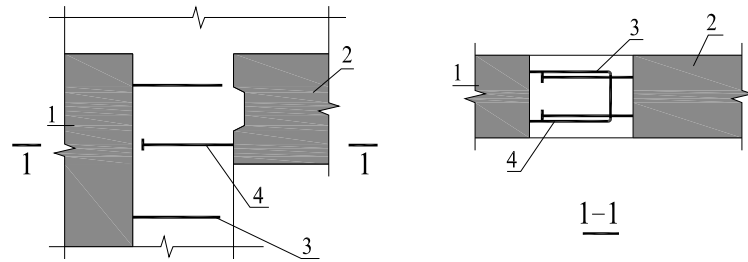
预制连梁钢筋在后浇段内锚固构造示意
